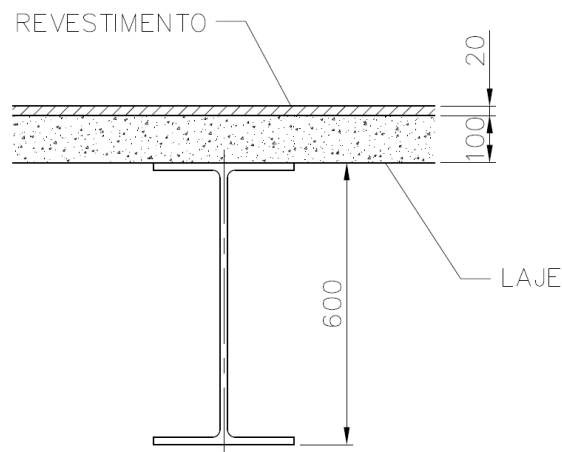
Seção Típica - Laje e Revestimento (mm).
